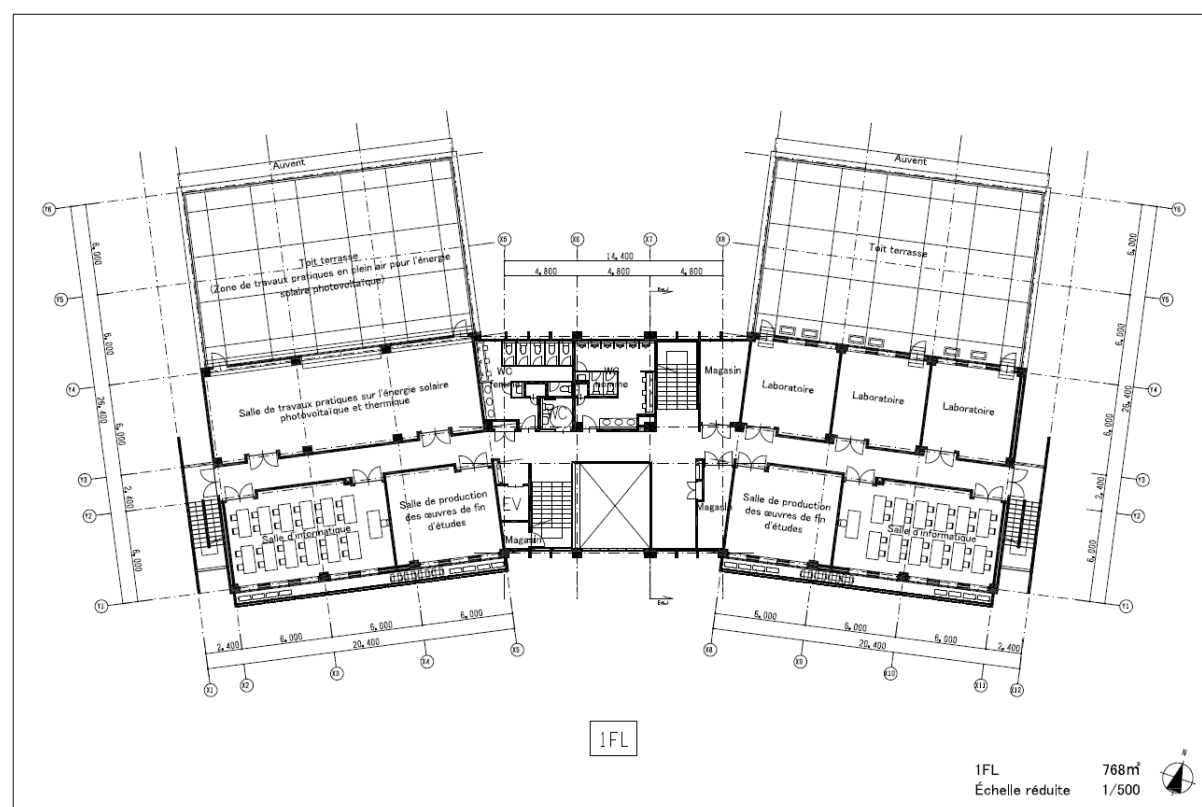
Plan d'étage du bâtiment principal 1er étage
